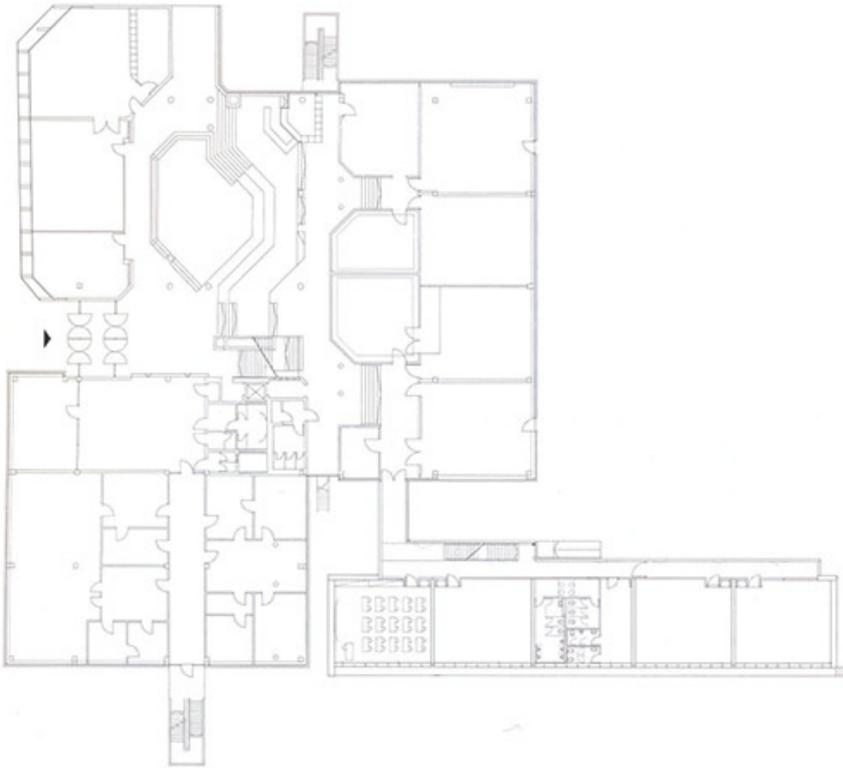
Grundriss Erdgeschoss
